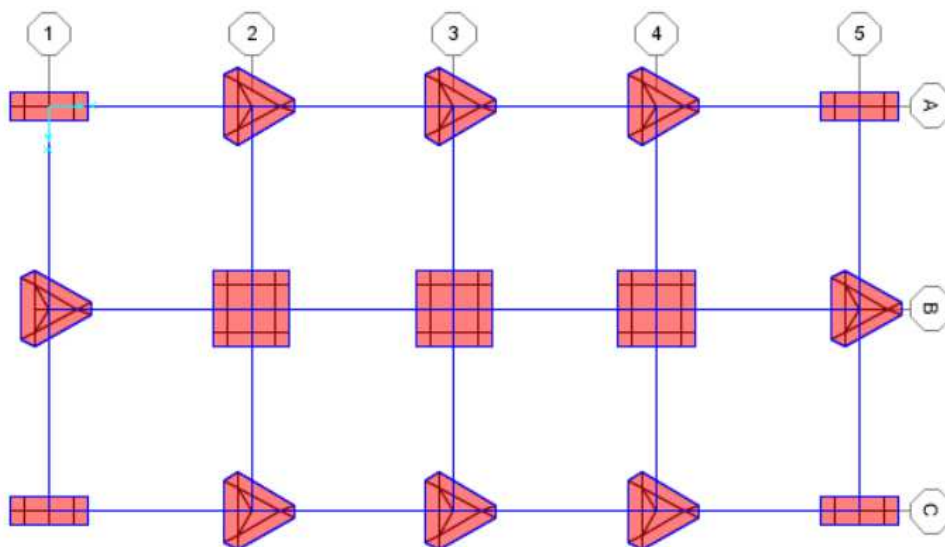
Planta baixa para as edificações de 12 pavimentos.
